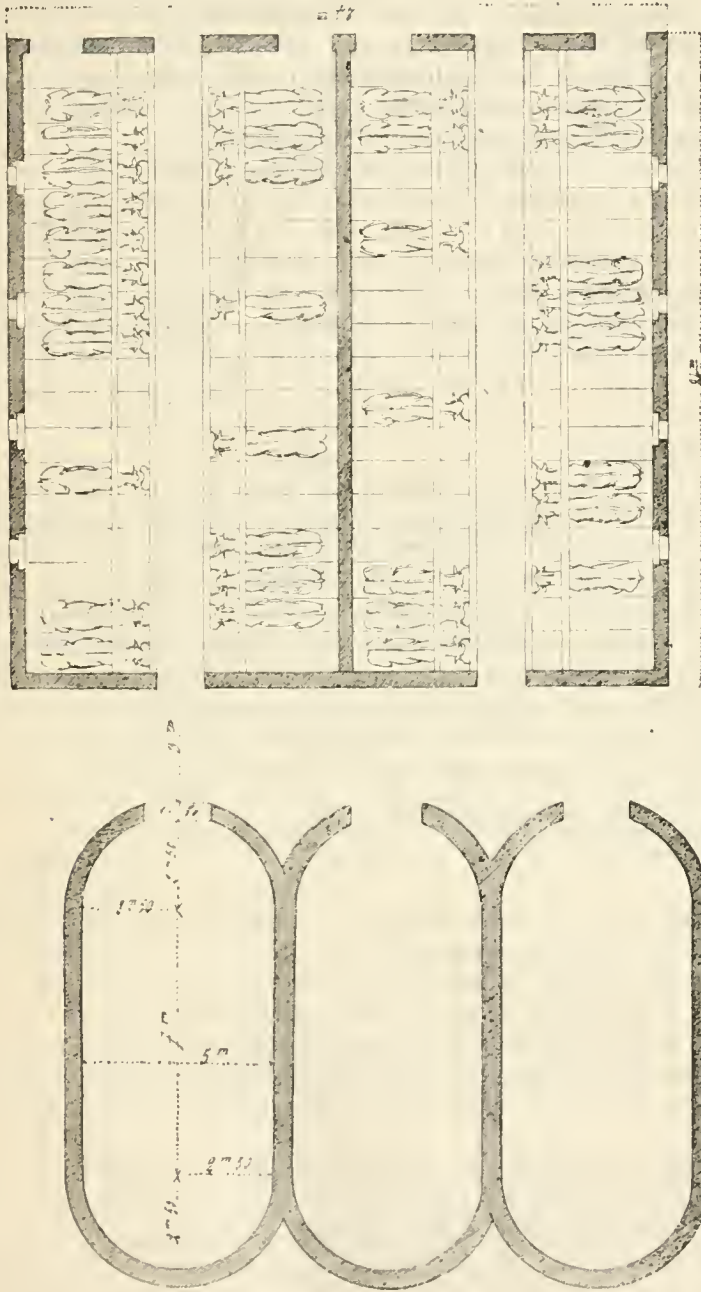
Plan des nouvelles étables de Burtin et de leur silo triple.
